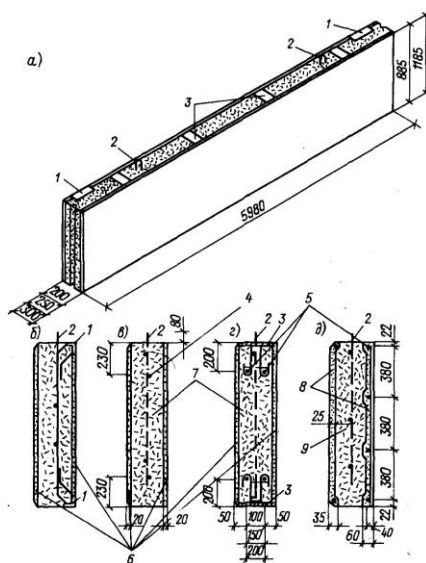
Конструкционные решения стеновых панелей для промышленных и сельскохозяйственных каркасных зданий
